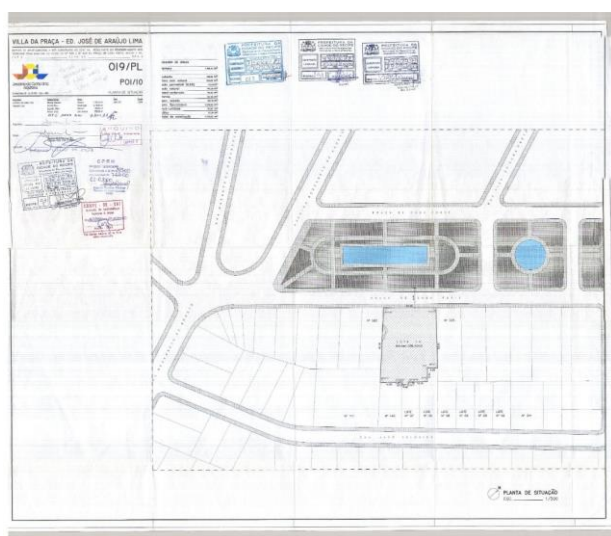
Planta de Localização do Edifício Villa de Praça. Fonte: Arquivo da Prefeitura de Recife (1999).
